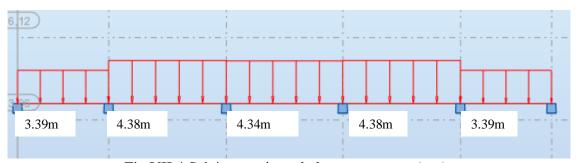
Schéma statique de la nervure sens (y-y).
